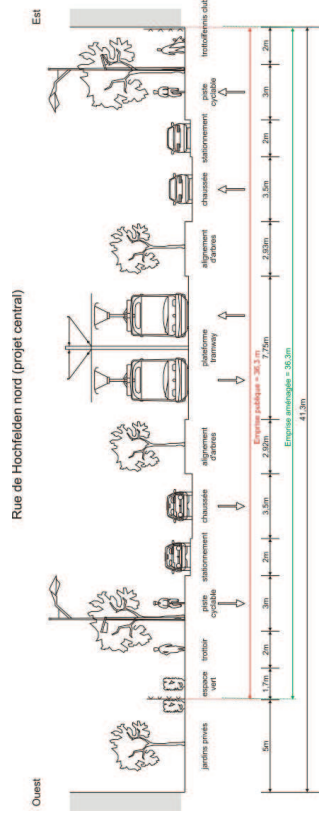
Situation projetée. Coupe d'insertion sur la rue de Hochfelden
